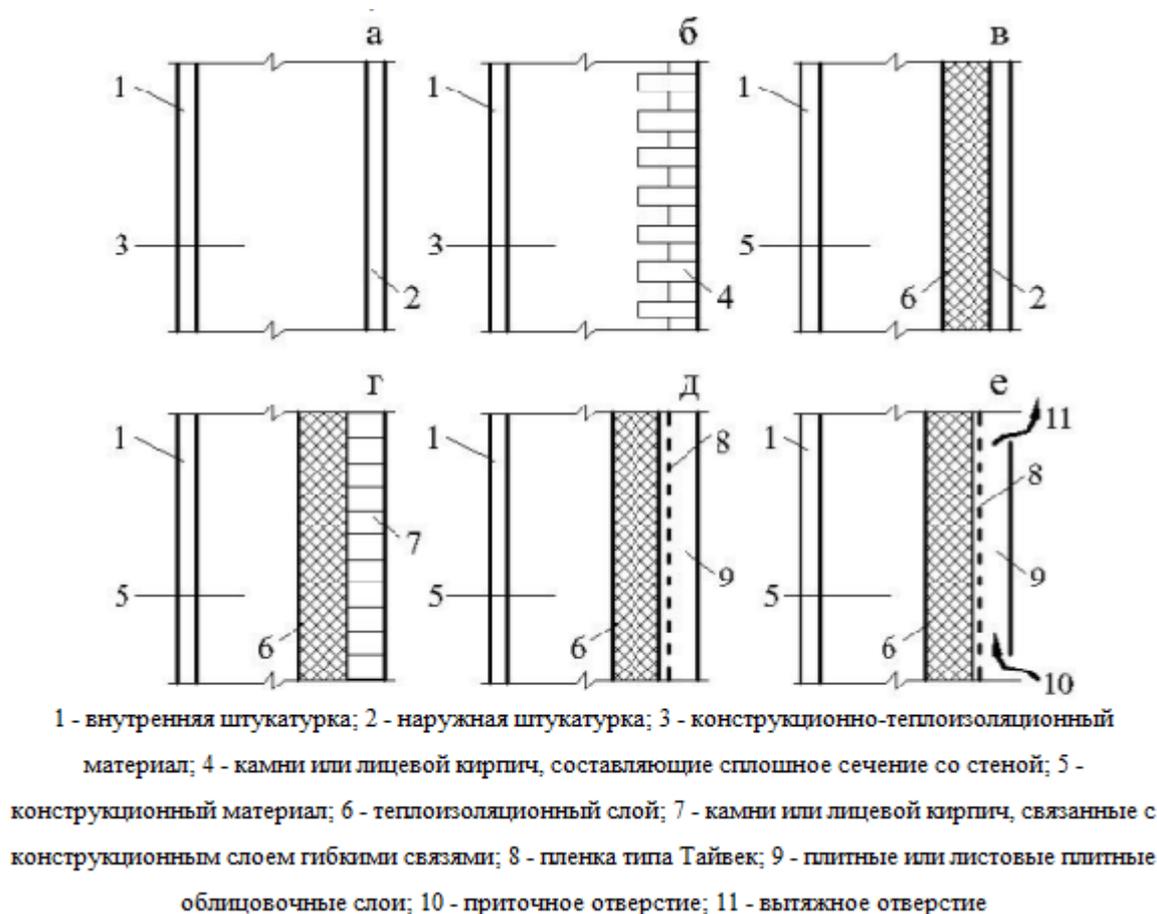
Основные схемы конструктивных решений наружных стен, как объектов теплозащиты: а, б – сплошные (однослойные) стены; в – двухслойные стены с штукатуркой по сетке и наружным утеплением; г – трехслойные стены с облицовочным слоем из камня или кирпича; д – стена с неветилируемой воздушной прослойкой; е – стена с вентилируемой воздушной прослойкой.
